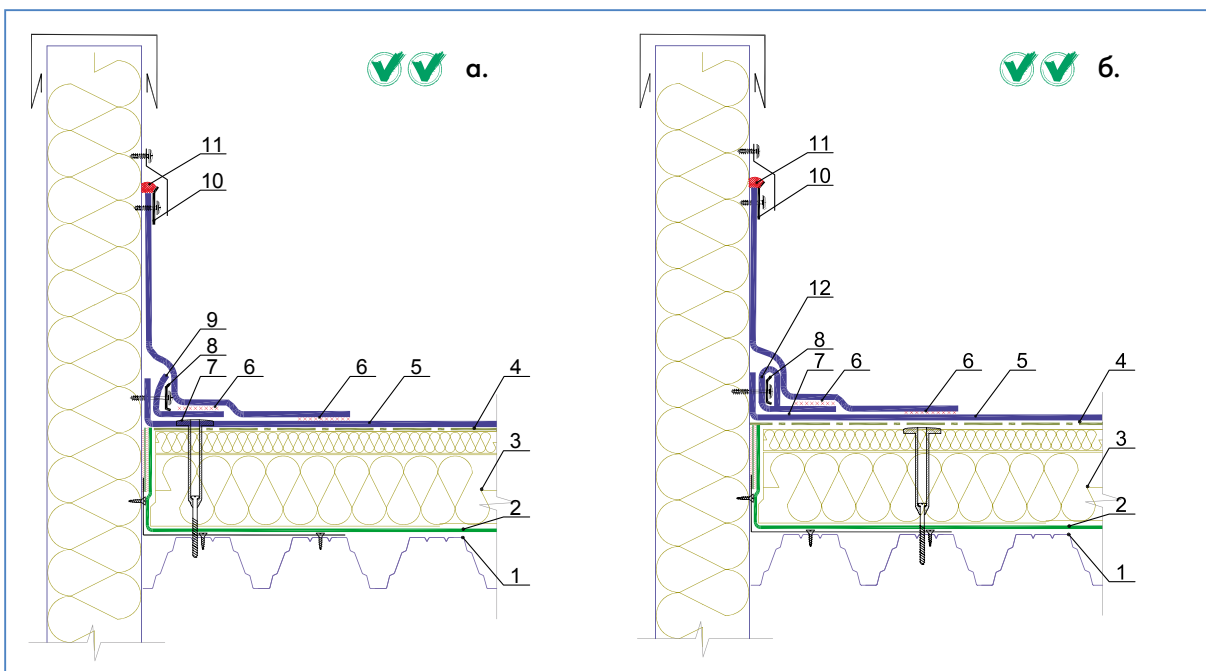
Устройство примыкания кровельного ковра к вертикальной поверхности с усиленным креплением
